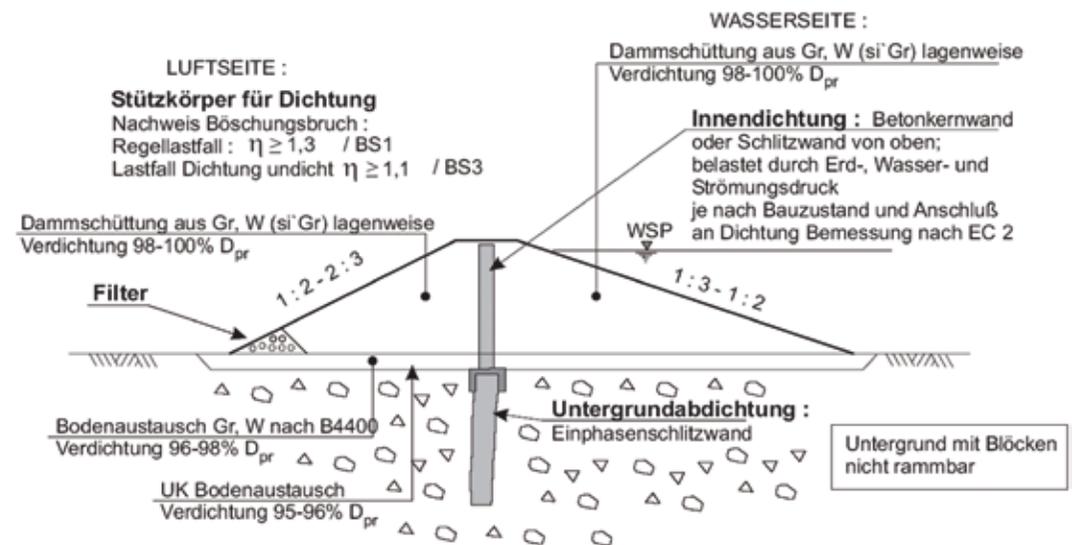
Bautyp – Damm mit Innendichtung in Form eines Betonkerns und als Untergrundabdichtung eine Einphasenschlitzwand
